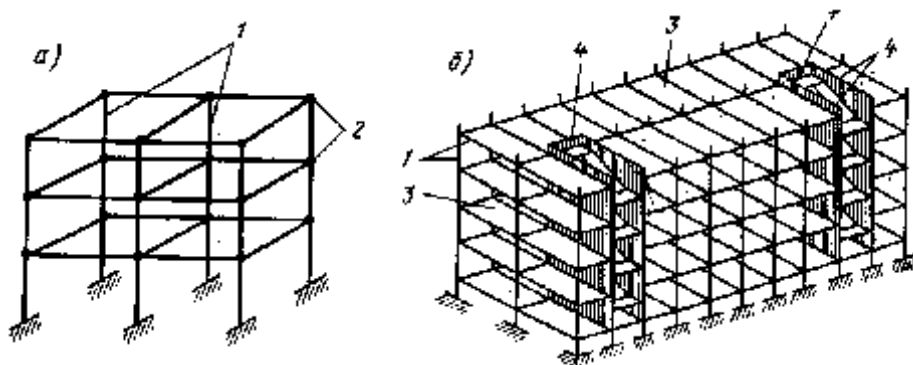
Схемы каркасов зданий: 1 – элементы каркаса; 2 – жесткие узлы, 3 – горизонтальные диафрагмы; 4 – вертикальные поперечные и продольные диафрагмы.
